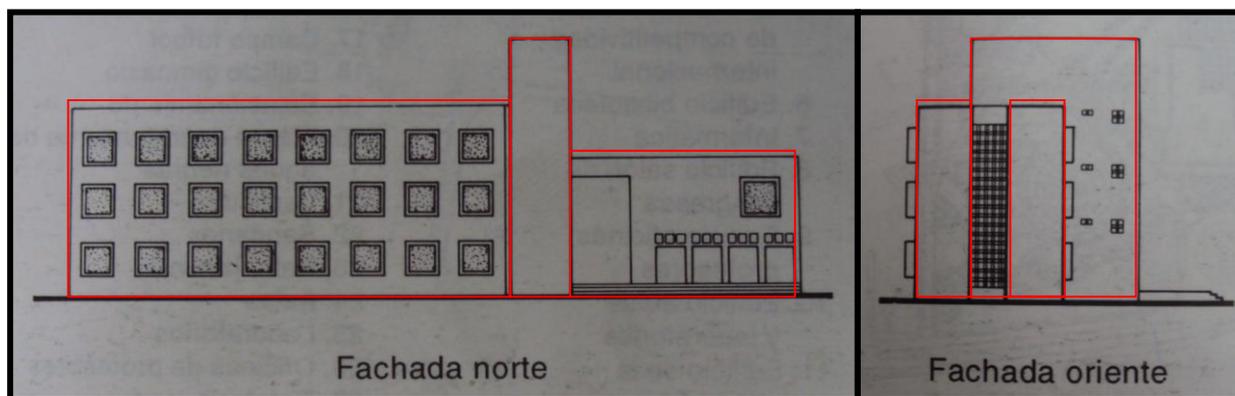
Fachadas Norte y Oriente Edificio de Ciencias Administrativas ITESO
